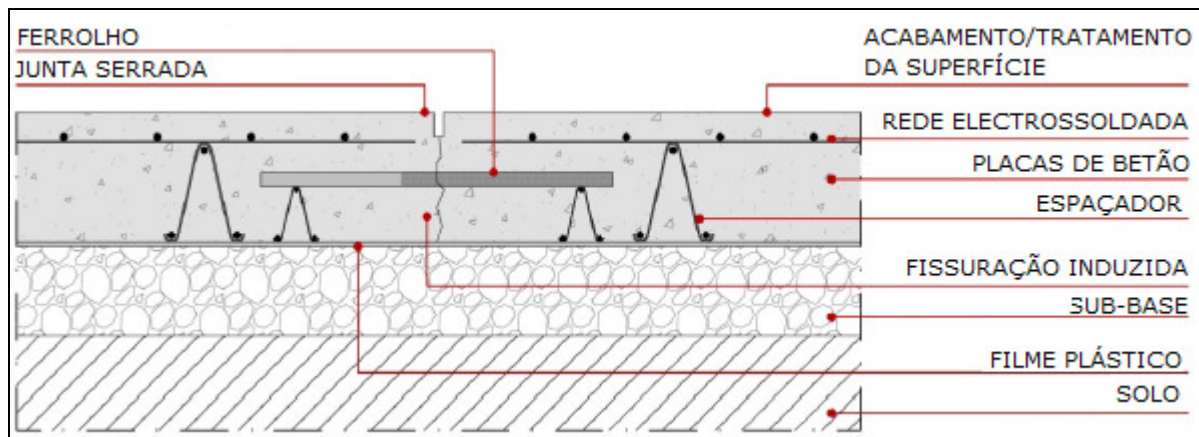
Corte: Pavimento industrial de betão reforçado com rede electrossoldada (Cristelli, 2010).
